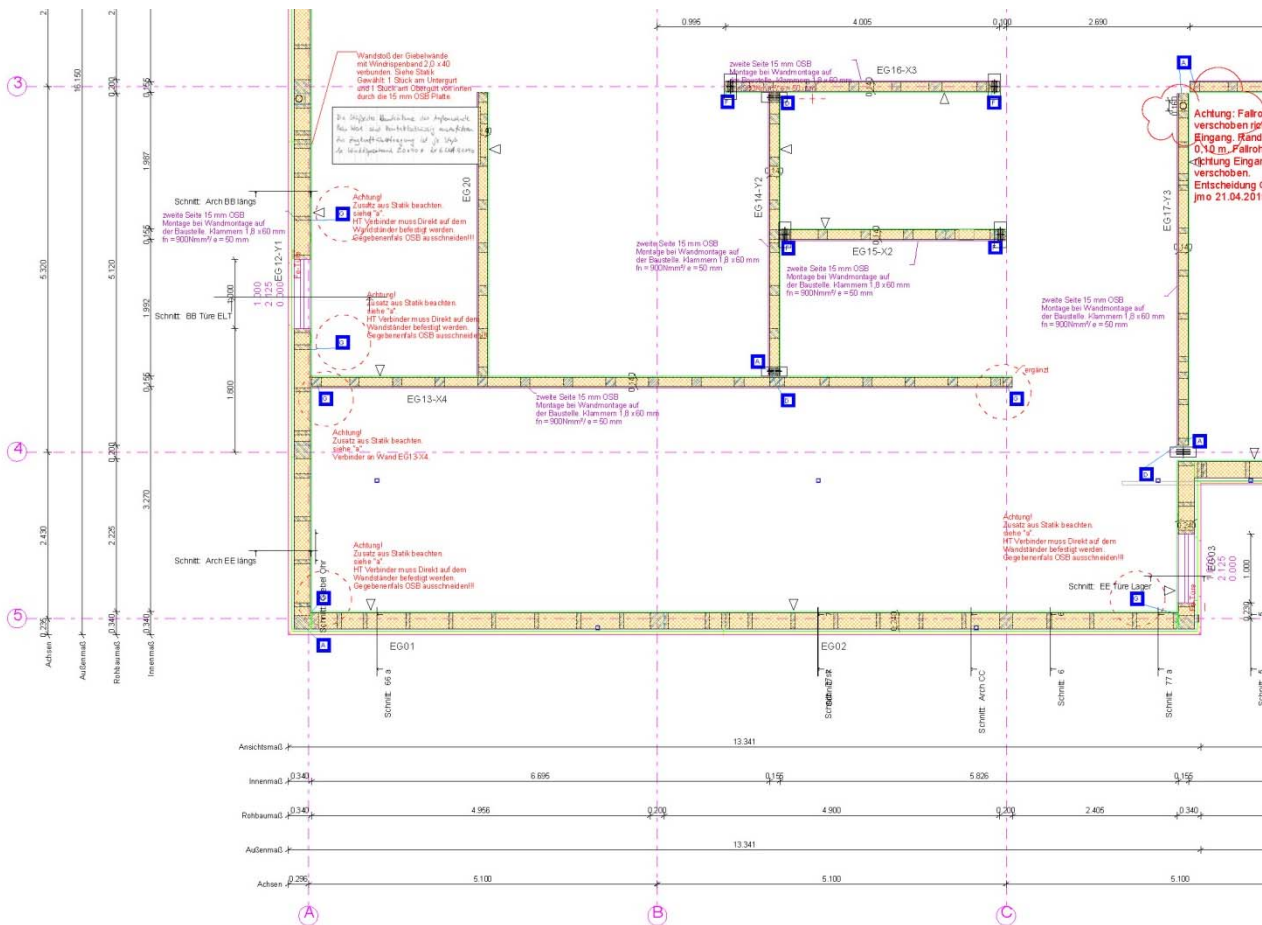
Ausschnitt aus einem Montageplan für die Baustelle mit Elementbenennungen
